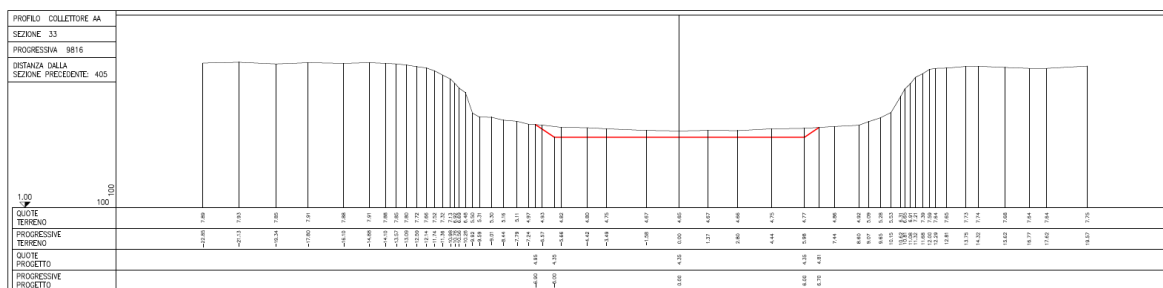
Sezione trasversale di scavo esempio del tratto più a monte (sez 33).
